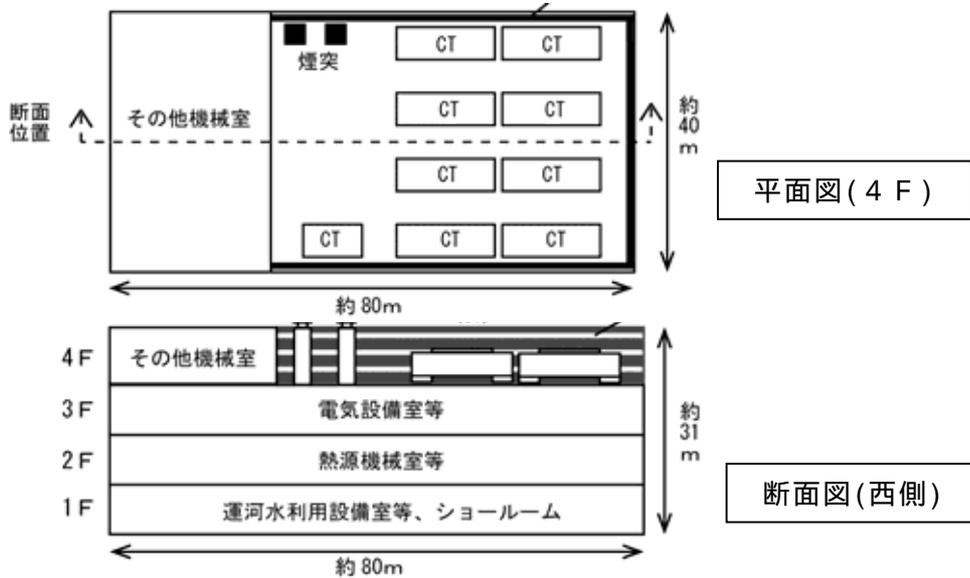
(1) エネルギー施設 A の平面図及び断面図
